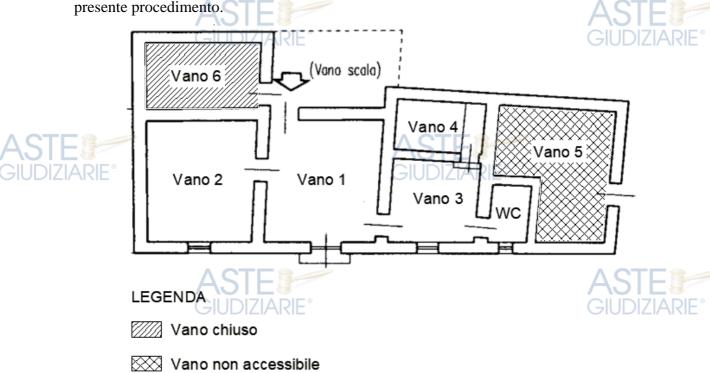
Stralcio planimetria piano primo Foglio n. 46 p.lla 1790 sub. 10 Comune di Sala Consilina
